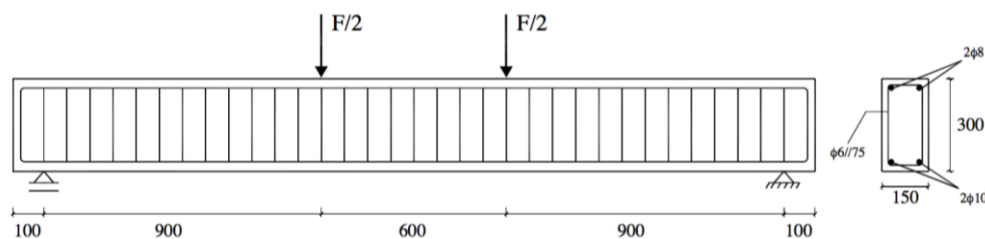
Geometria das vigas propostas por DIAS *et al.* (2012)
